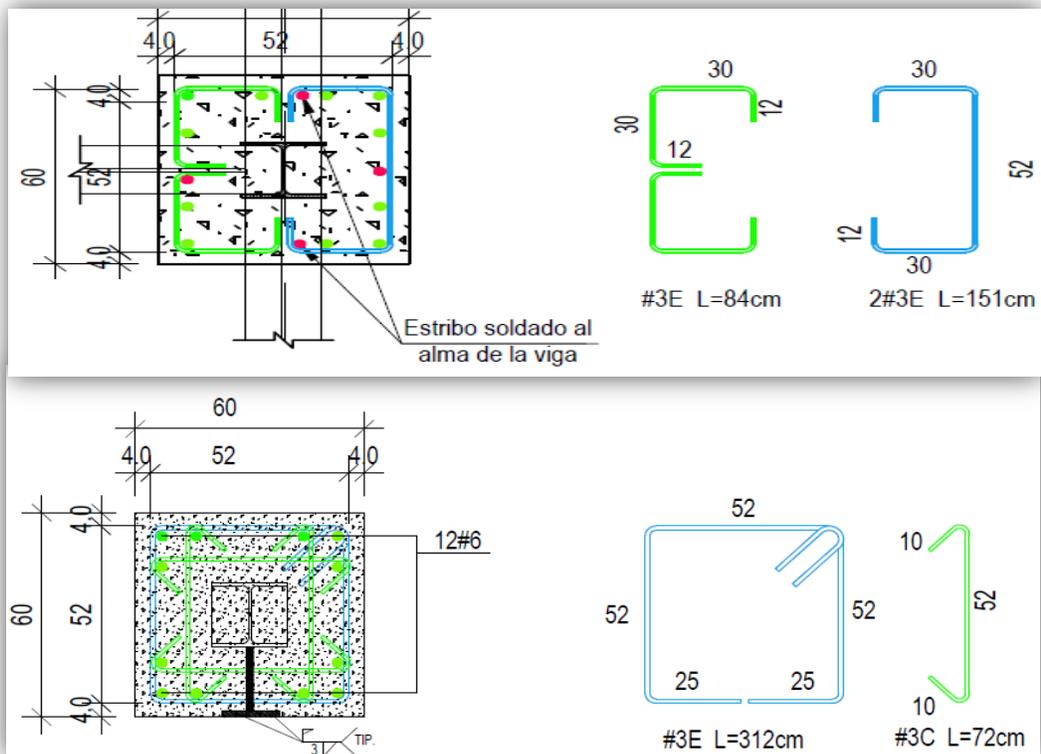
Refuerzo transversal de las columnas de 0.60 m x 0.60 m en los nudos
